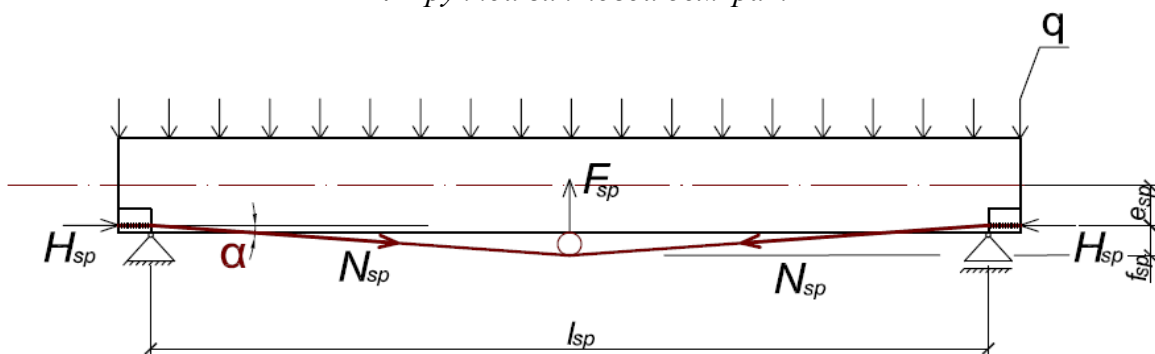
Схема воздействий на локально обжатую железобетонную балку
